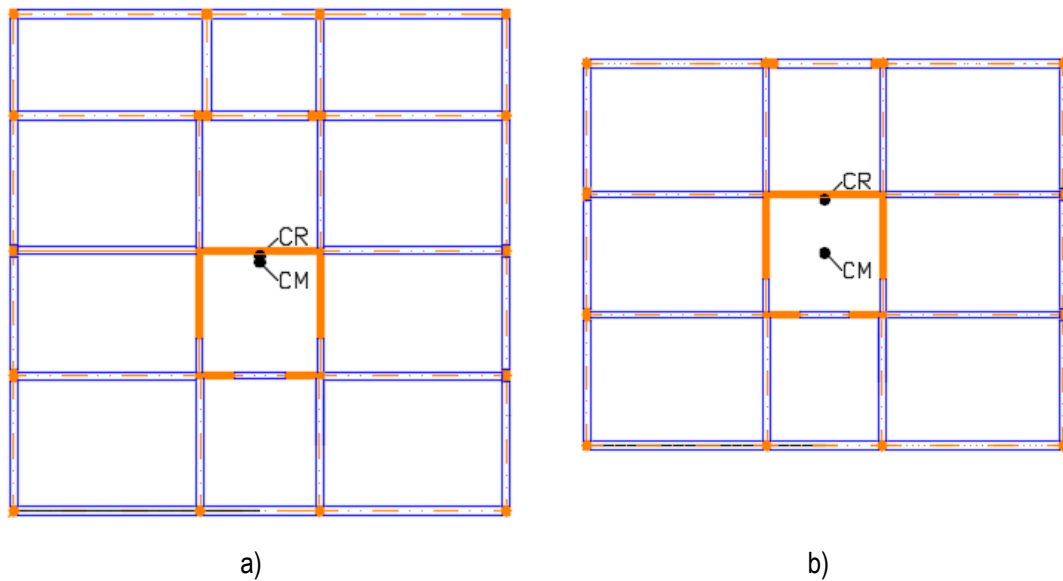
Localização do centro de massa e do centro de rigidez; a) planta da cave/ rés-do-chão; b) planta dos pisos
